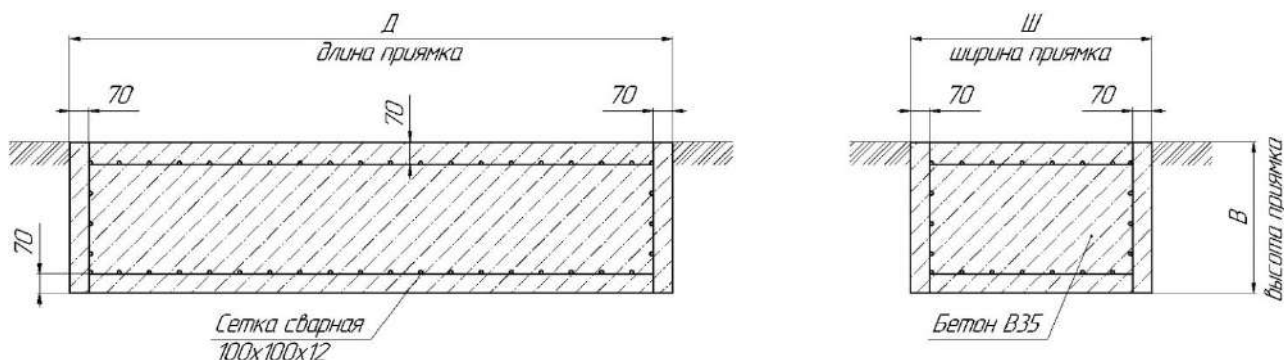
Схема армирования бетонного основания (Изм. №2)
